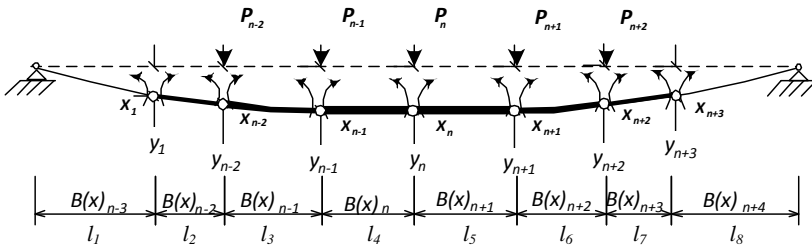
Вісь залізобетонної плити перекриття в деформованому стані.
